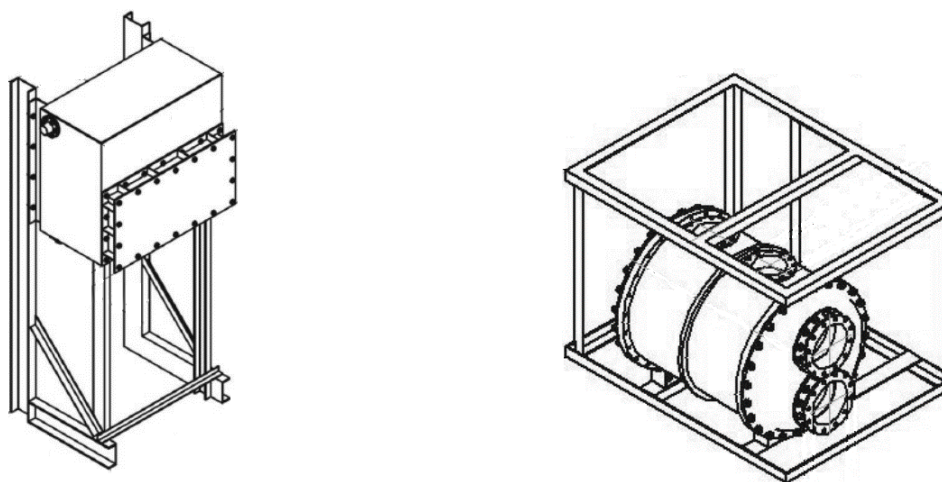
Сталеві опорні конструкції обладнання типової конструктивної форми «підлоговий каркас»
